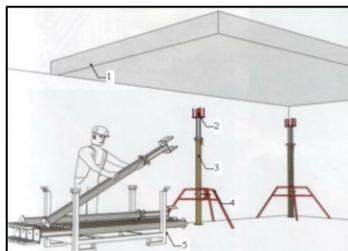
Демонтаж основных стоек: 1 – вновь возведенное перекрытие; 2 – унвилка; 3 – стойка; 4 – тренога; 5 – контейнер для складирования элементов опалубки
